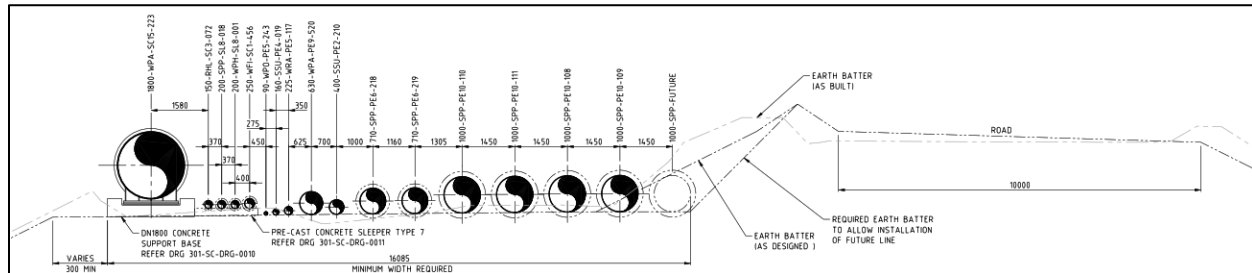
1: Sección Típica de las Tuberías (Sección A - 1824-301-PI-DRG-0109_rev2)
